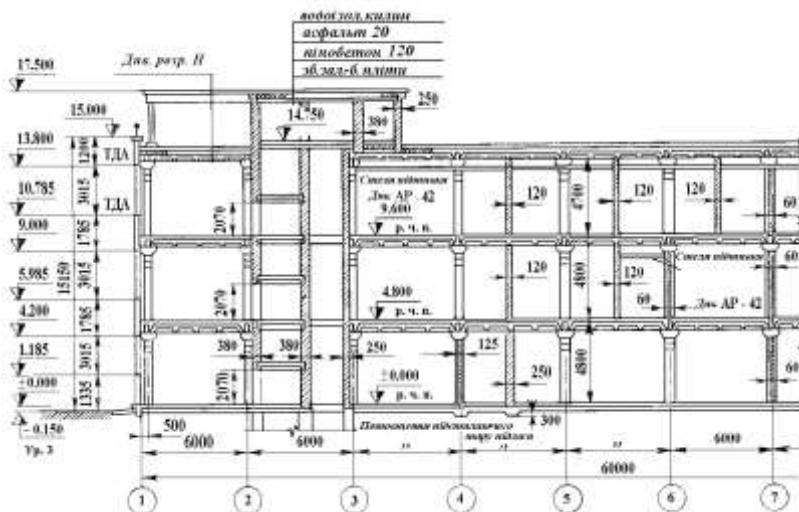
Приклад графічного оформлення подовжного розрізу багатоповерхової промислової будівлі із збірними залізобетонними конструкціями
